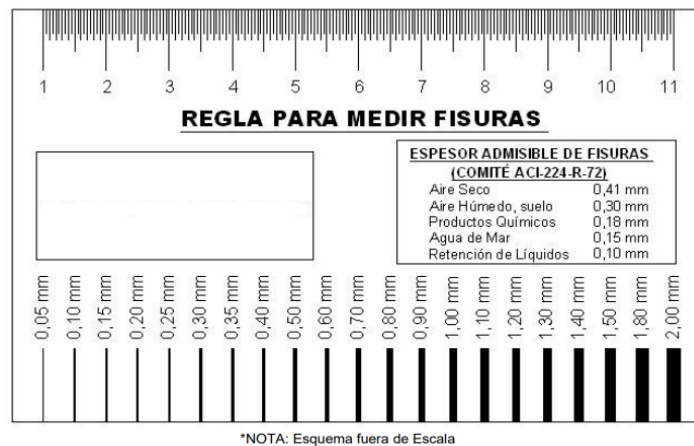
Comparador de fisuras o fisurómetro de bolsillo. [10]
